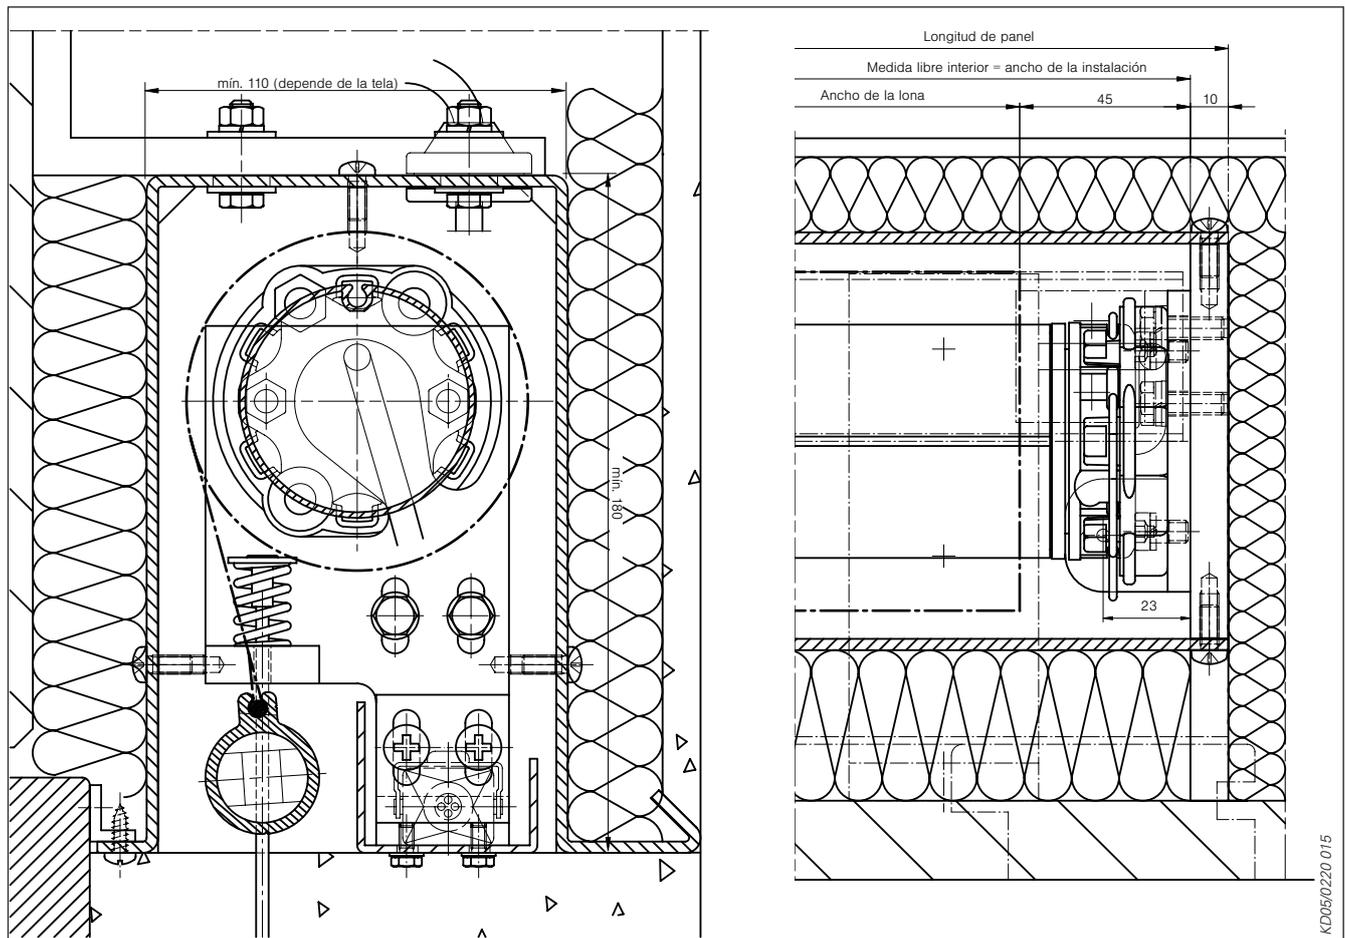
Toldo para fachadas modelo 209 E con guía de cable en fachada con aislamiento térmico.
